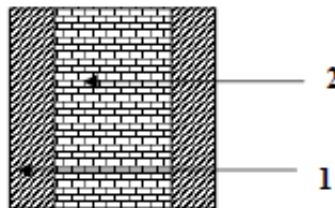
Coupe verticale, Eléments d'un mur intérieur.
